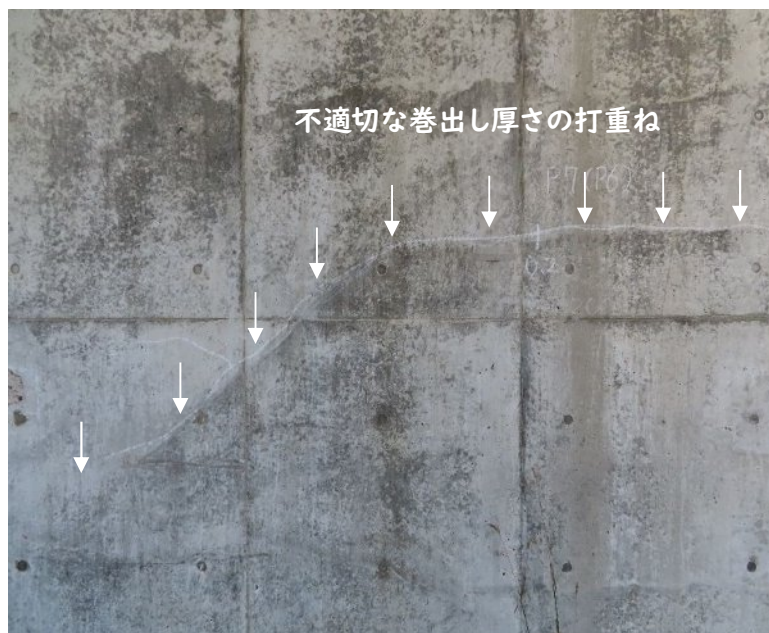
打継ぎ箇所のひび割れ，剥離・剥落
